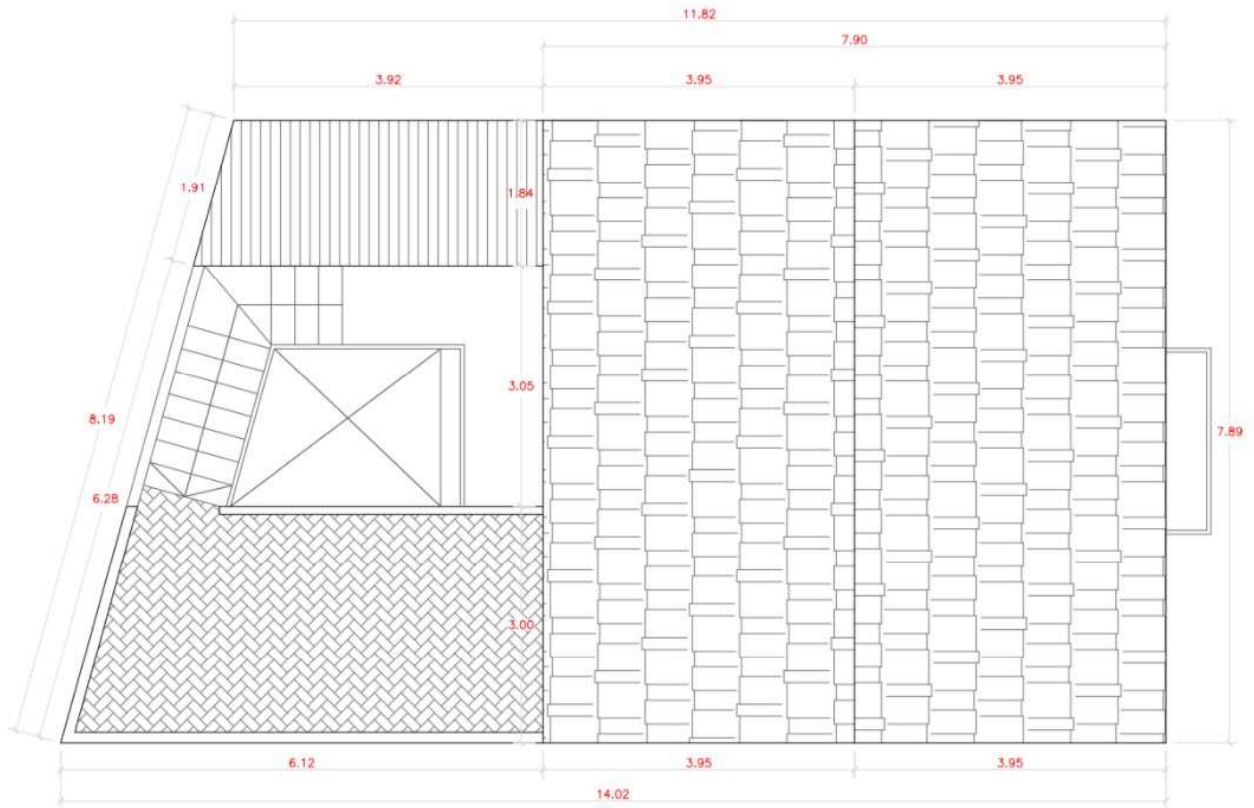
Estado inicial de la planta cubierta (proyecto básico)
